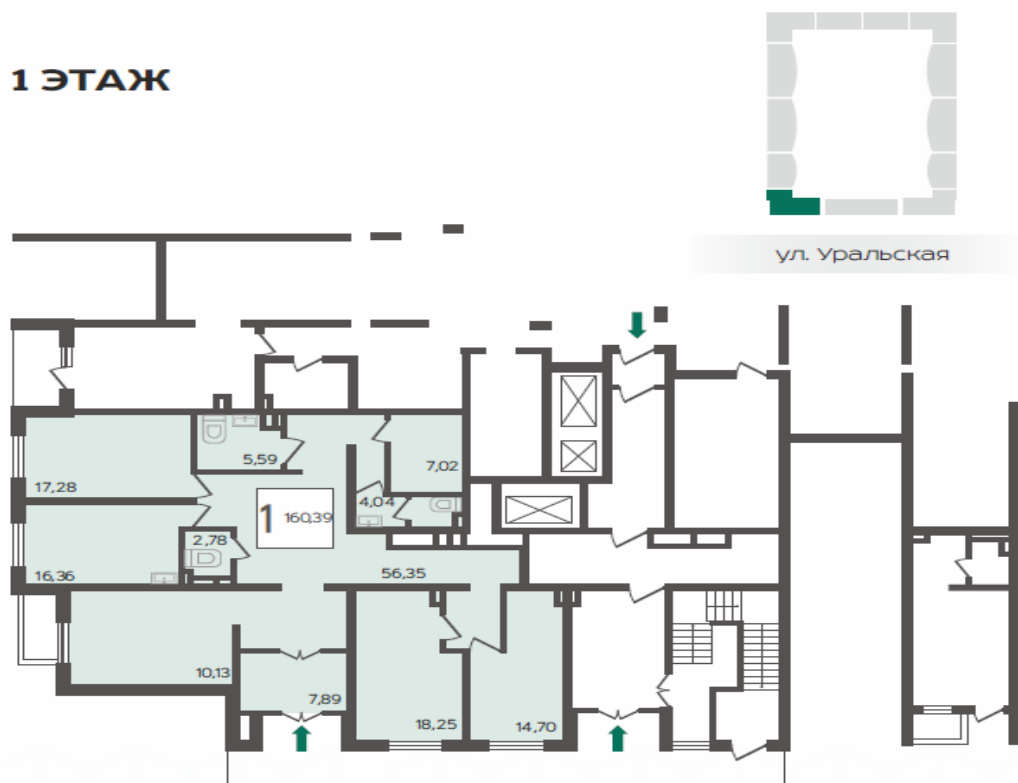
План коммерческих помещений 1 этажа БС-1 ЖК URAL
